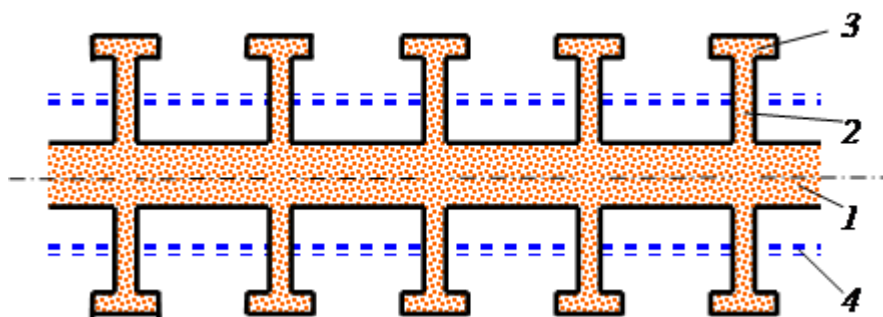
Схема расположения прорезей для установки гибких опор, удерживающих подземный трубопровод на проектной отметке 1 – траншея; 2 – поперечные прорезы в грунте; 3 – продольные прорезы в грунте; 4 – прогнозируемая граница ореола оттаивания мерзлого грунта
